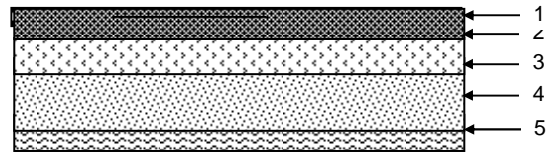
Plancher étage courant (dalle en corps creux)
